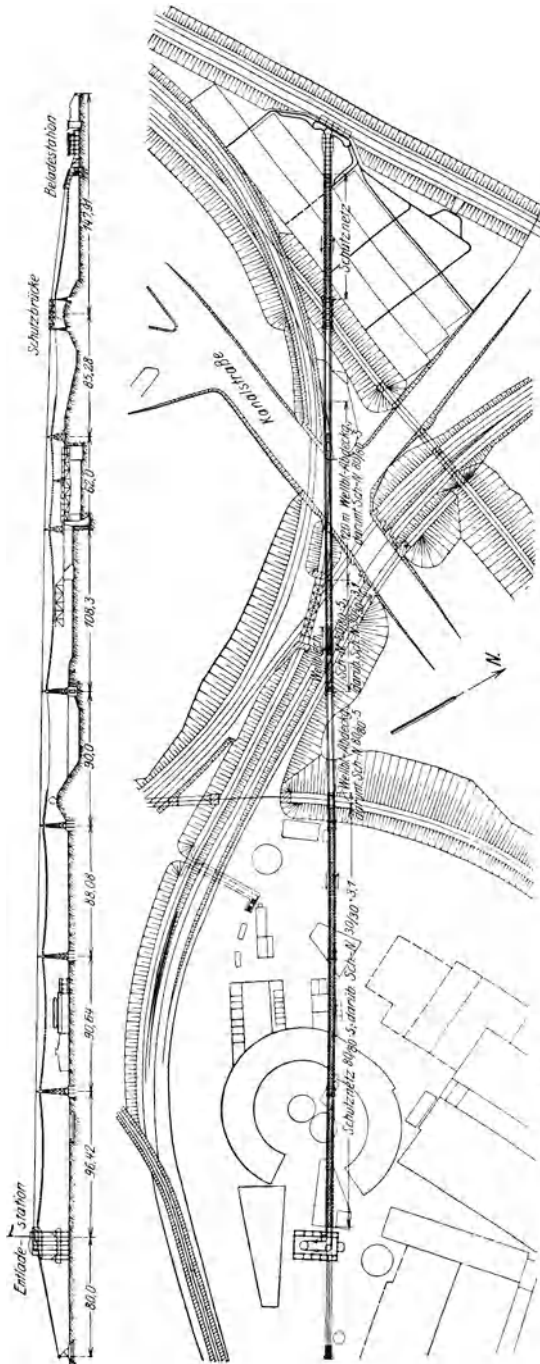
Lageplan und Längsprofil der Drahtseilbahn Köln-Gereon (Pohlig).
